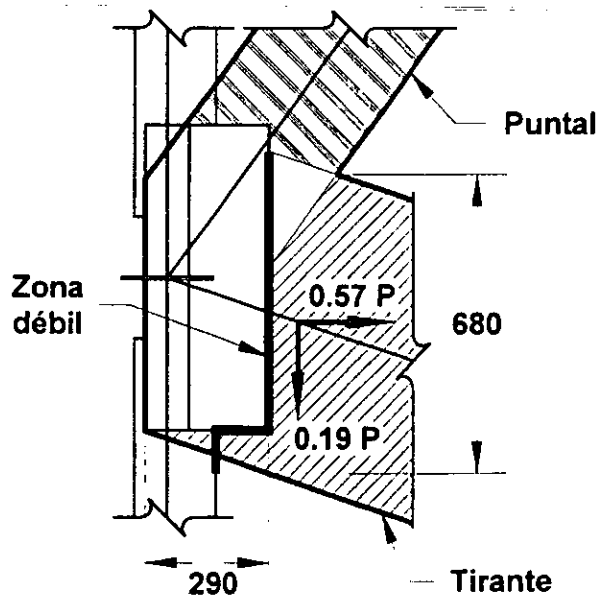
Detalle de zona crítica para modelo 1 (dimensiones en mm)
